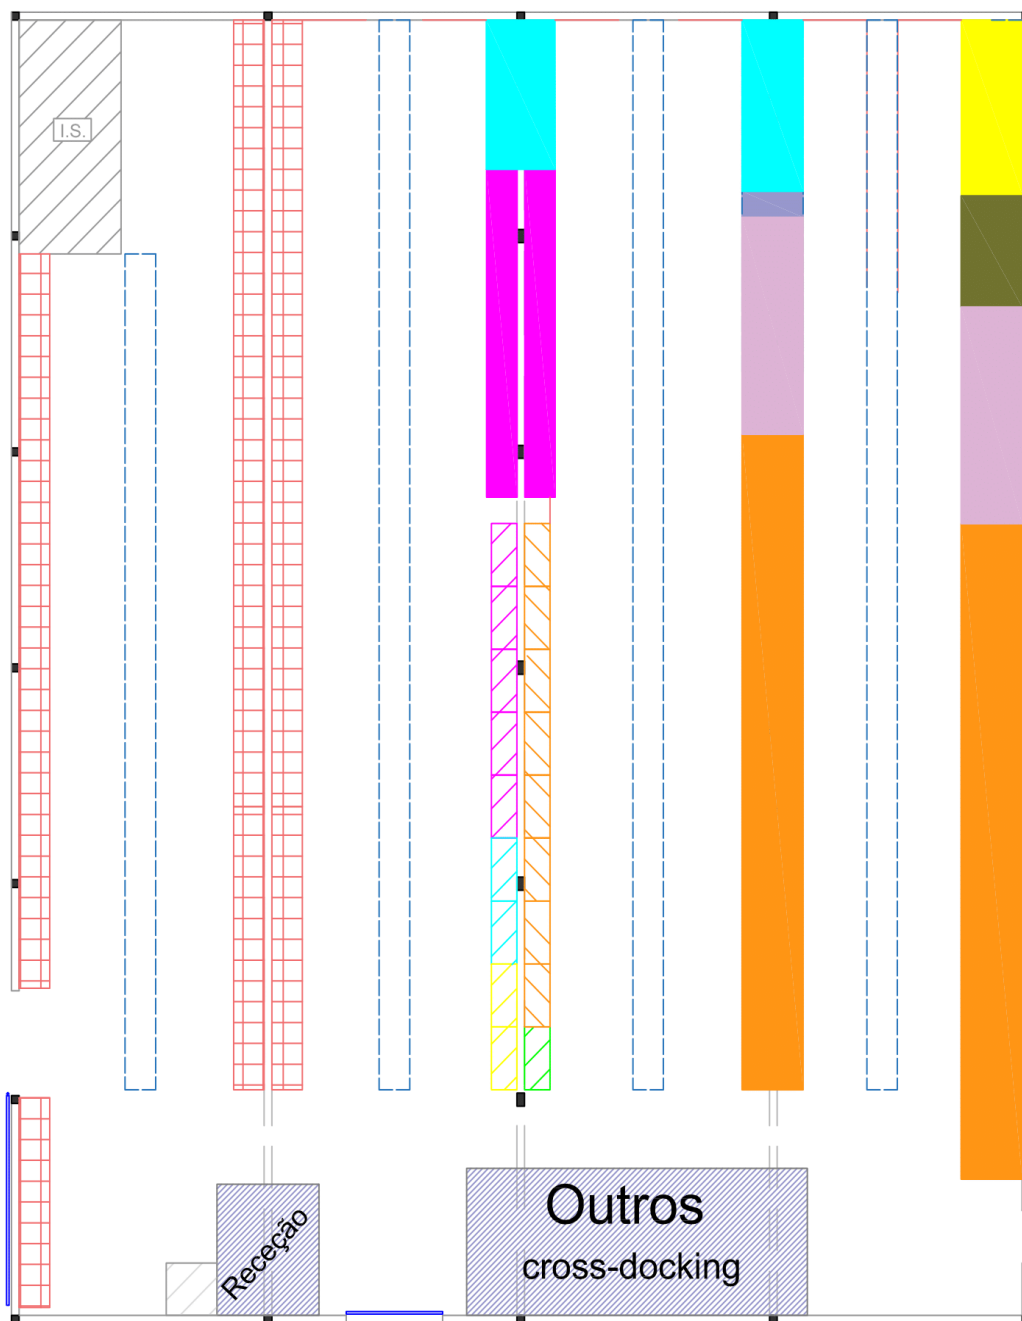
Layout 1. Disposição do peso pelas vigas e pilares de sustentação.
